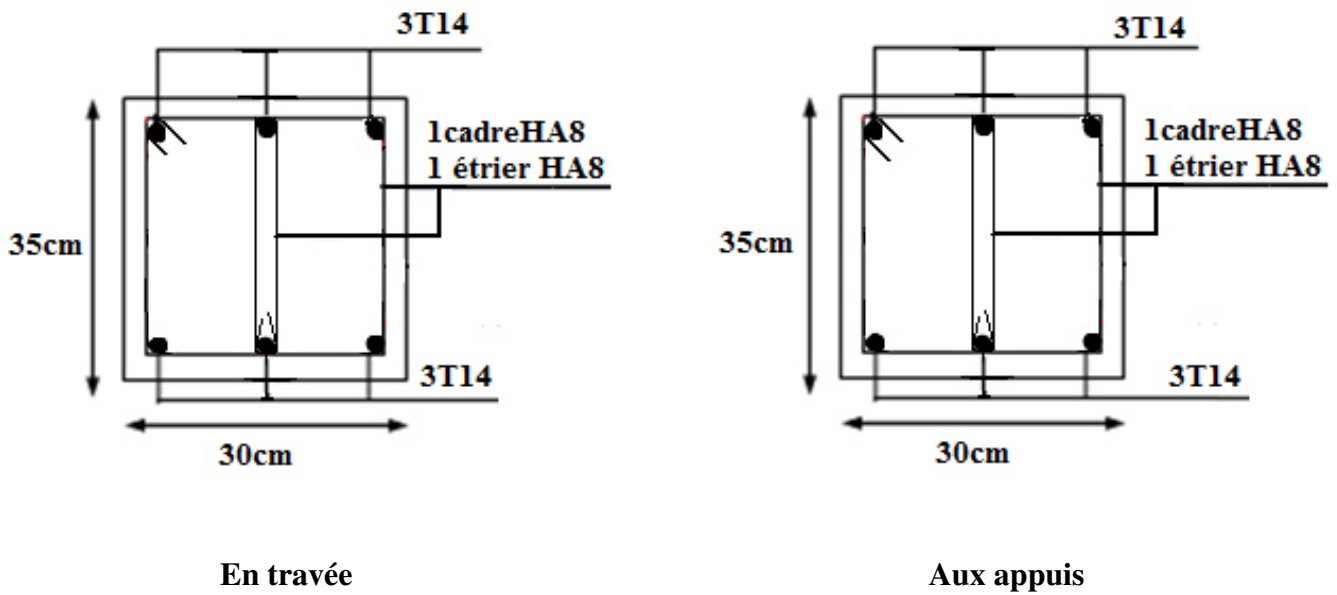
Schéma de ferrailage des poutres Secondaires.
